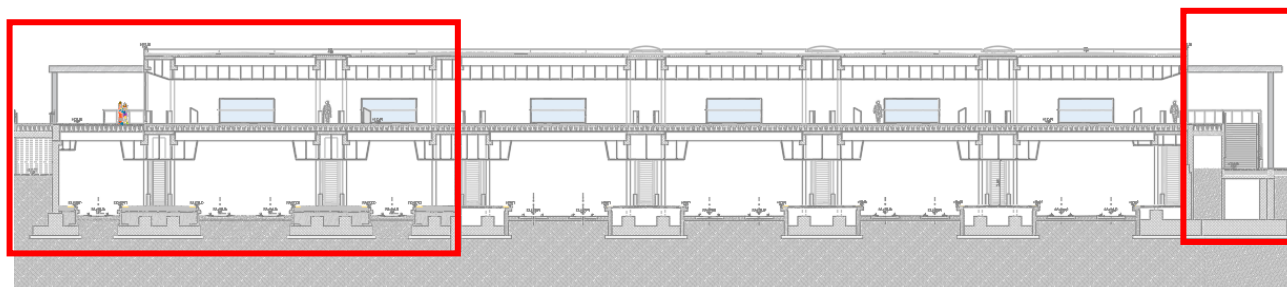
Sezione trasversale con indicazione dell’ampliamento.
